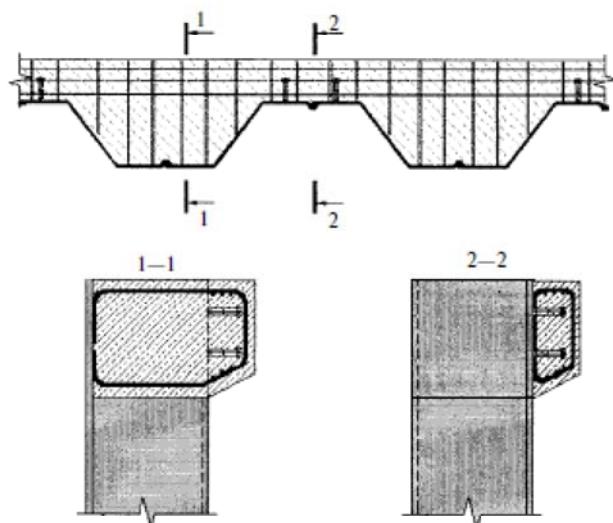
Узел опирания монолитных железобетонных балок по торцу шпунта для дальнейшего устройства плиты покрытия тоннеля [14]
